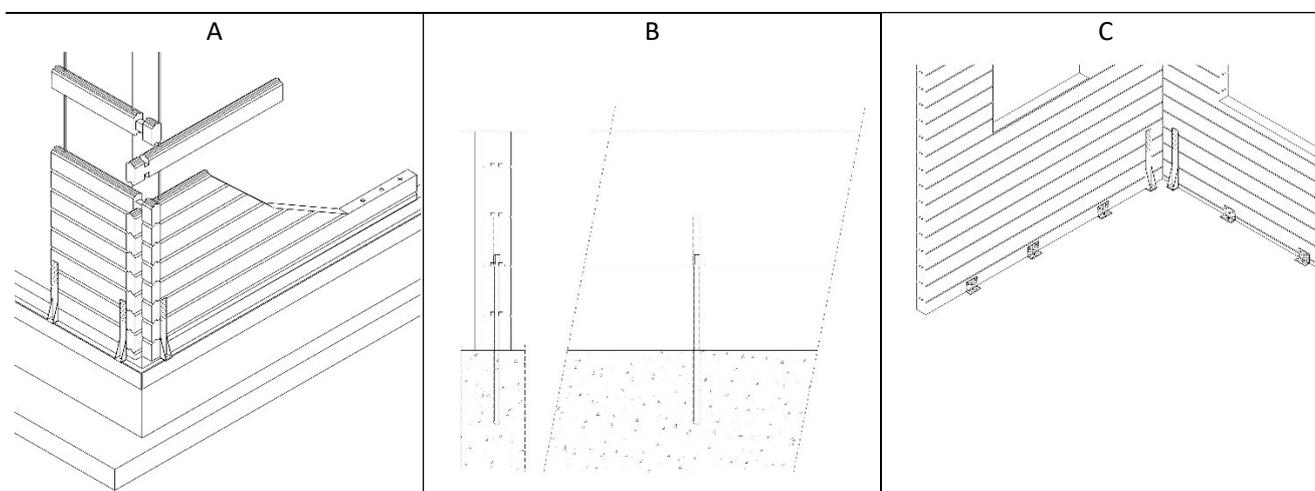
Soluzioni per il collegamento alle fondazioni. A dettaglio del collegamento alle fondazioni con hold-down (messi sul lato esterno per chiarezza ma solitamente posizionati sul lato interno) e barre d'acciaio e tirafondi per il collegamento a taglio. B particolare del collegamento a taglio con tirafondi in acciaio ancorati meccanicamente o chimicamente. C collegamento alle fondazioni con hold-down e angolari
